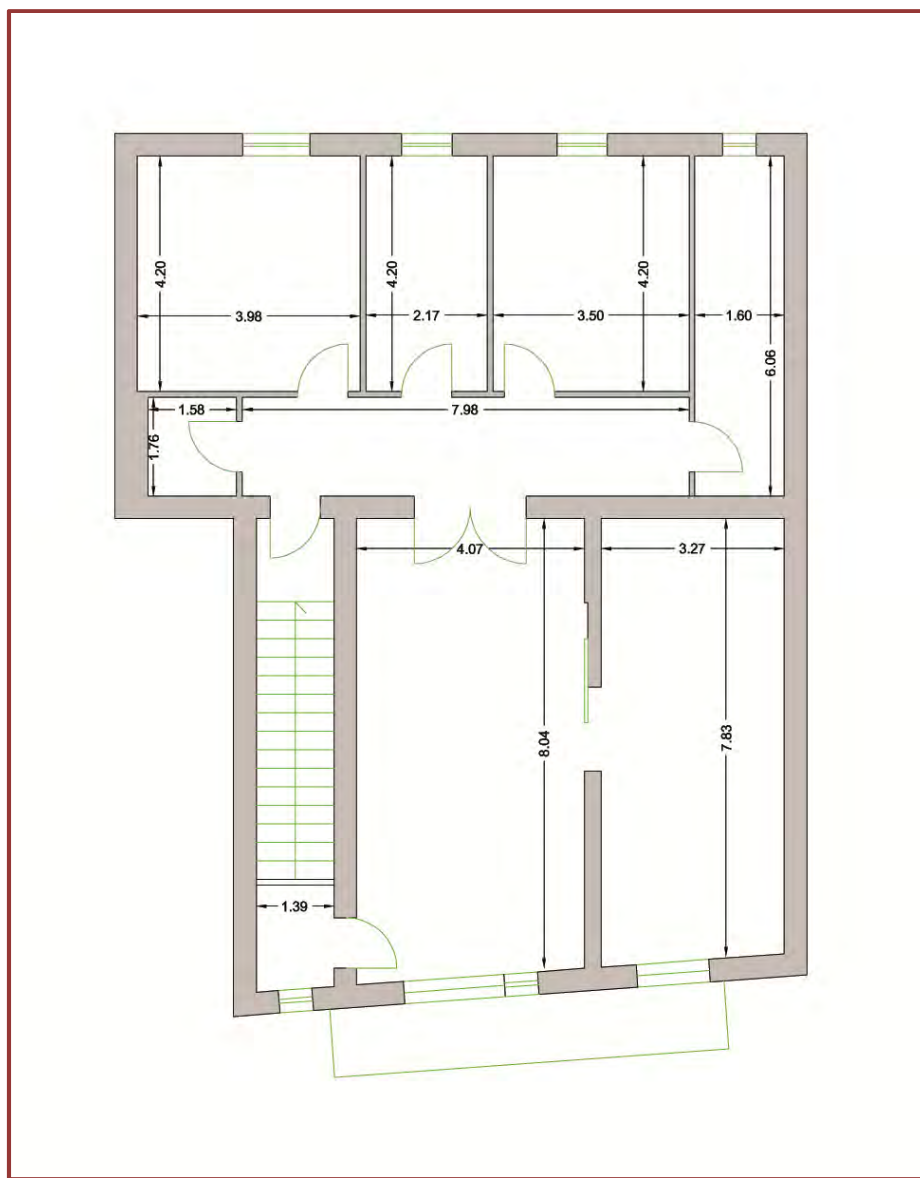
Appartamento al primo piano: planimetria reale e quotata.
